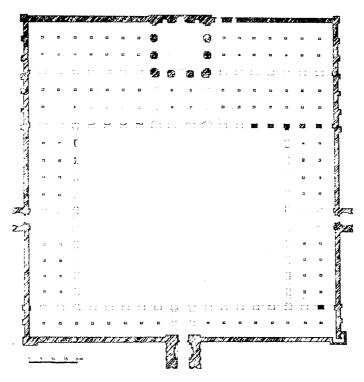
مكرر) مسقط أفقي للجامع الأزهر الحالي . (عن : كريزول) .
